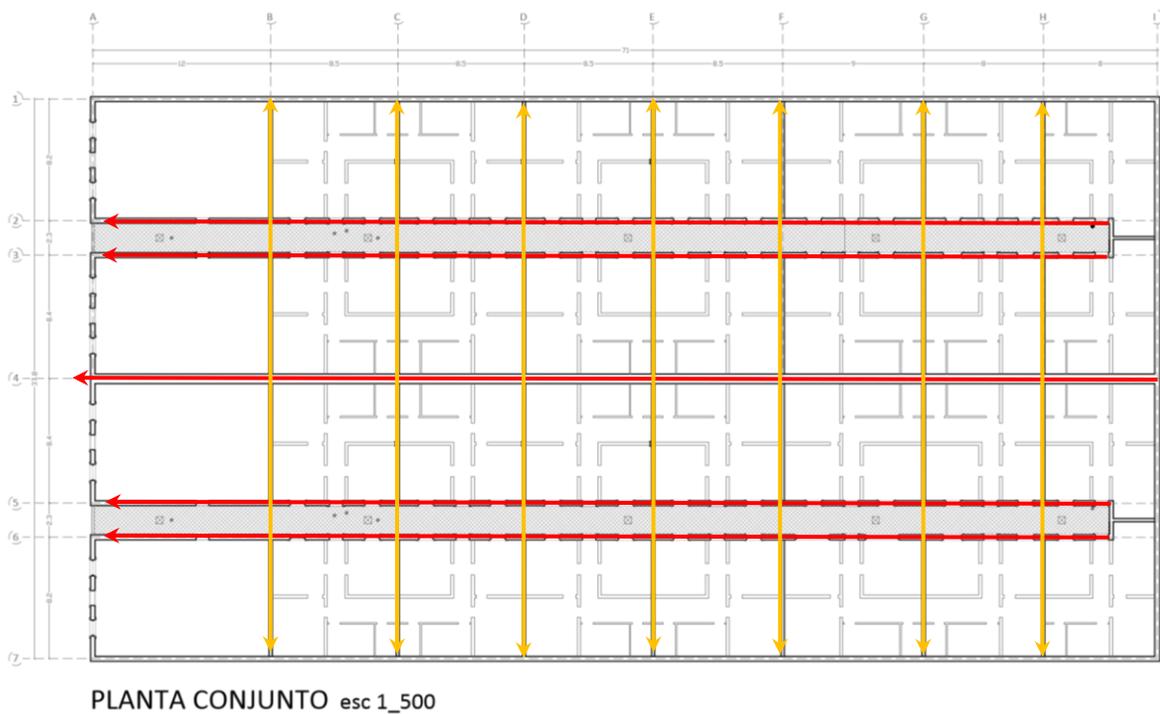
Planta conjunto intervenida, se muestra en rojo los ejes paralelos y en naranja los ejes verticales.
